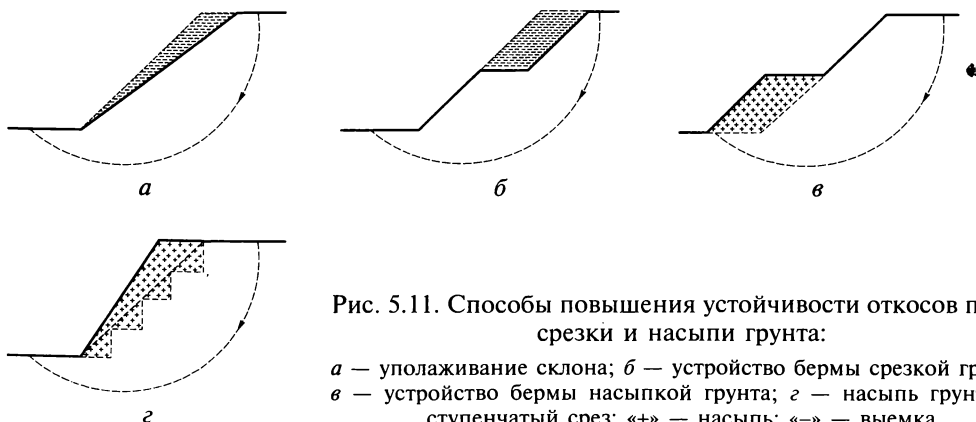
Способы повышения устойчивости откосов путем срезки и насыпи грунта:
